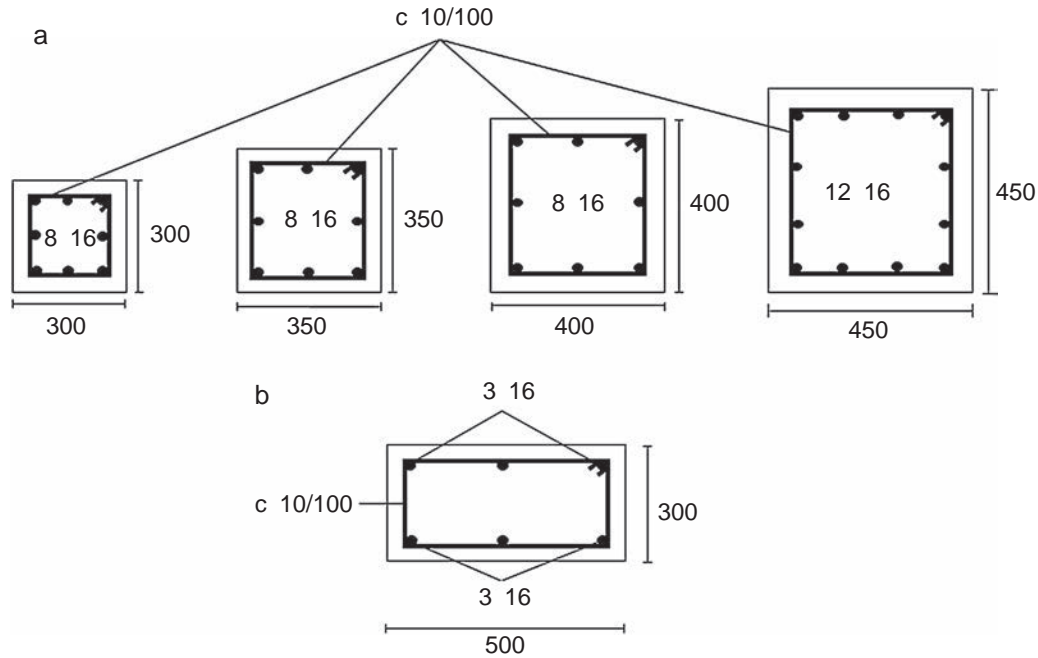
Secciones transversales de los elementos de los pórticos. a) Pilares. b) Vigas. (en milímetros).
